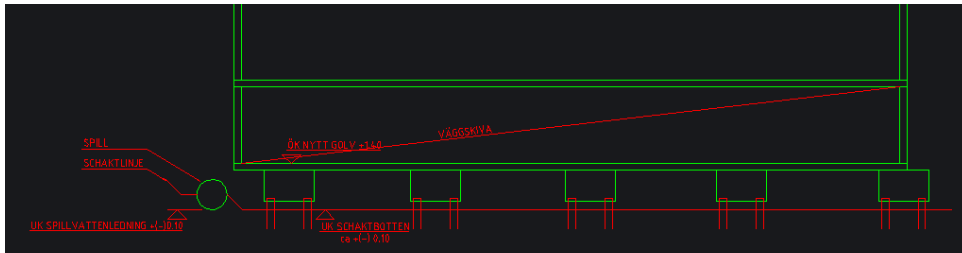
Elevation med exempel på hur byggnadens grund kan utformas för att hantera säkerhetsavståndet till ledningen med pågrundlagt utförande. Säkerhetsavstånd fastställs i projektering. Bildkälla: WSP
